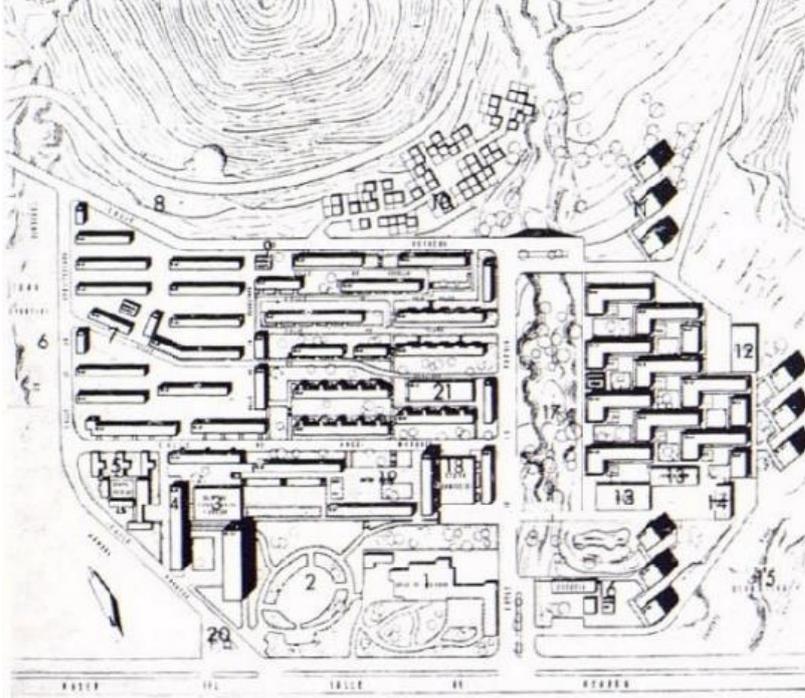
Segundo Plan Parcial de Ordenación Montbau, se agregan los bloques L.
